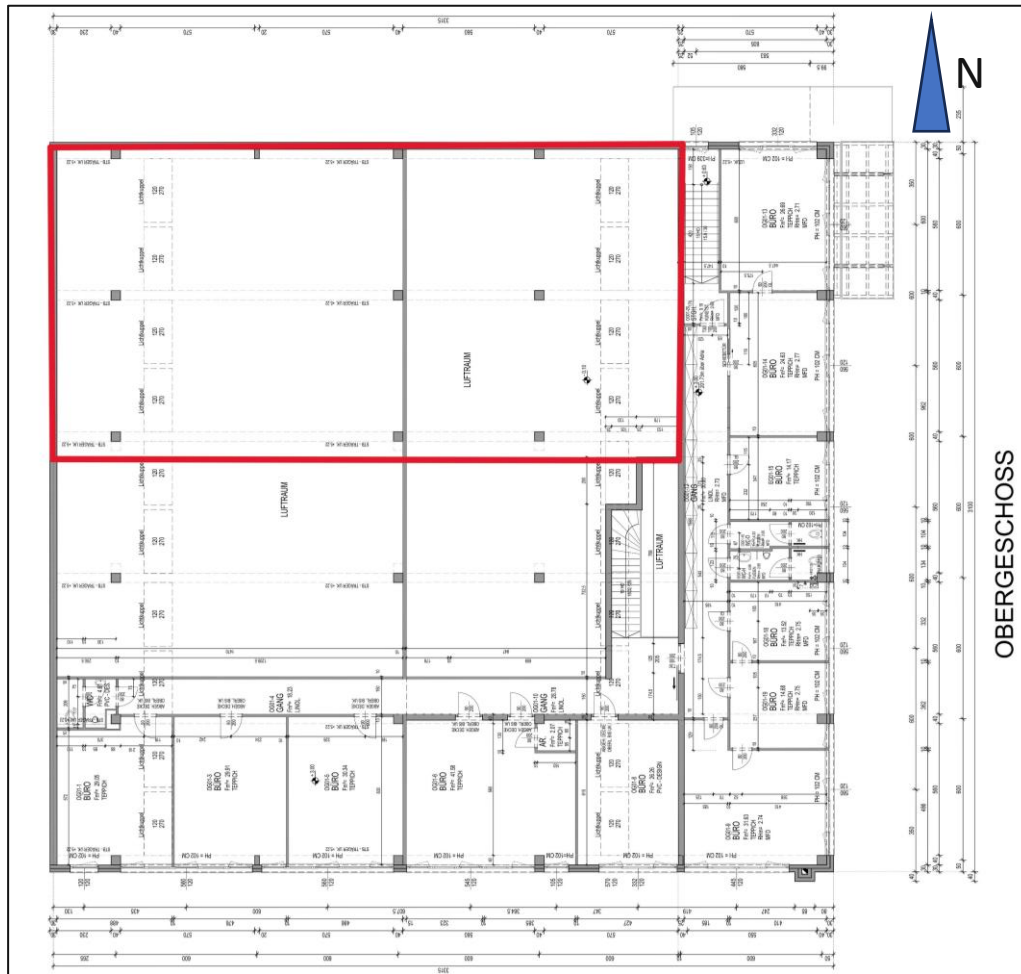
Grundriss im OG des Use Case A mit rot markiertem Scanbereich [35]
